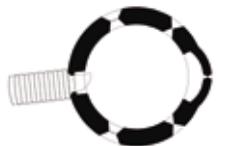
Grundriss Grünewald/Rottensteiner 2008. M 1:400.
